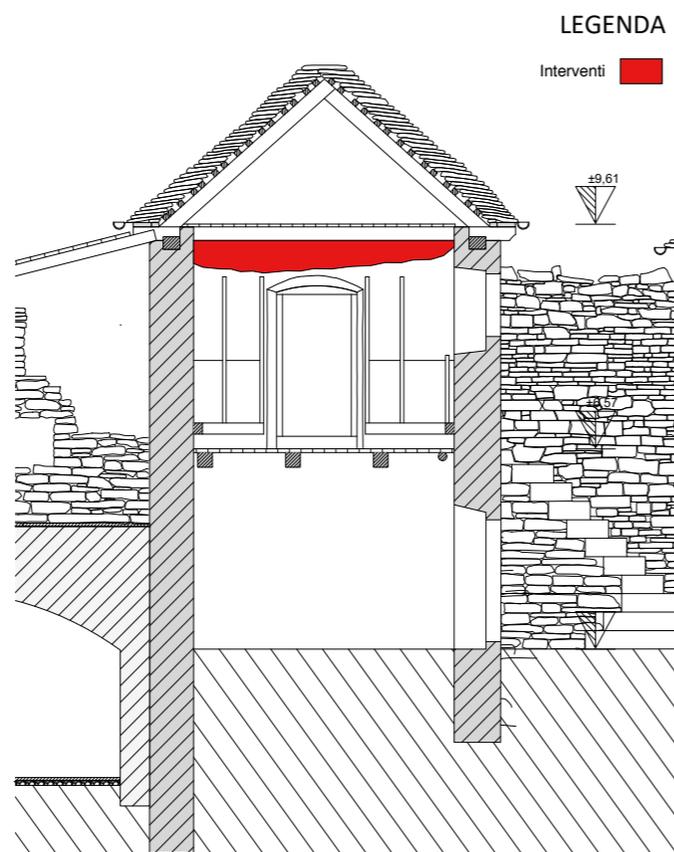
Evidenziazione interventi sulla muratura in sezione trasversale.
